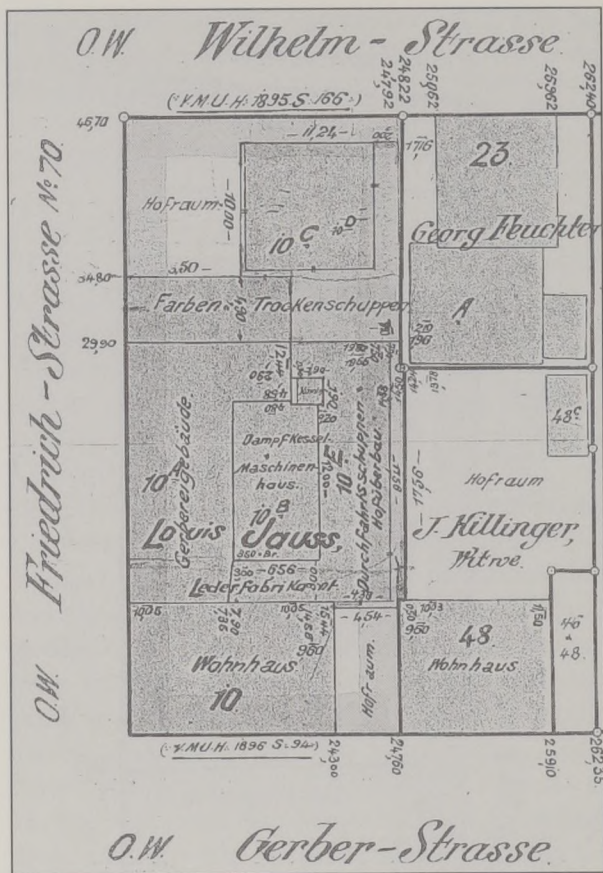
Lageplan von der Lederfabrik Louis Jauß auf dem Grundstück Friedrichstraße 10 mit dem Zustand vom Jahr 1906.
